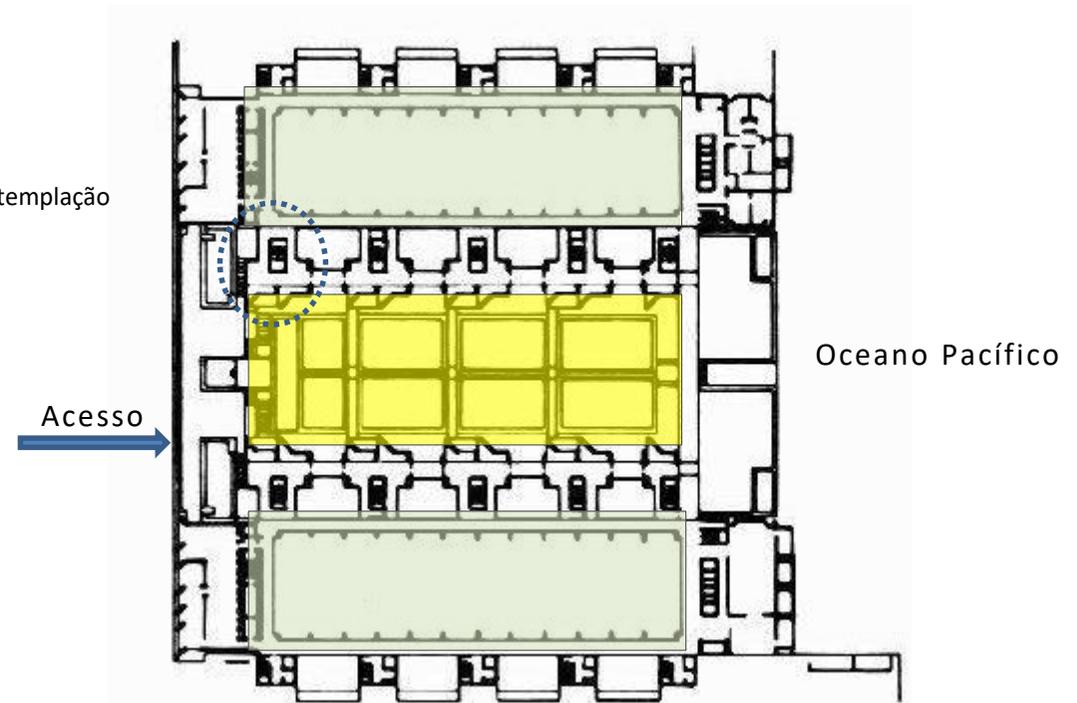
Instituto Salk, planta baixa . Fonte : Archdaly (2013)
